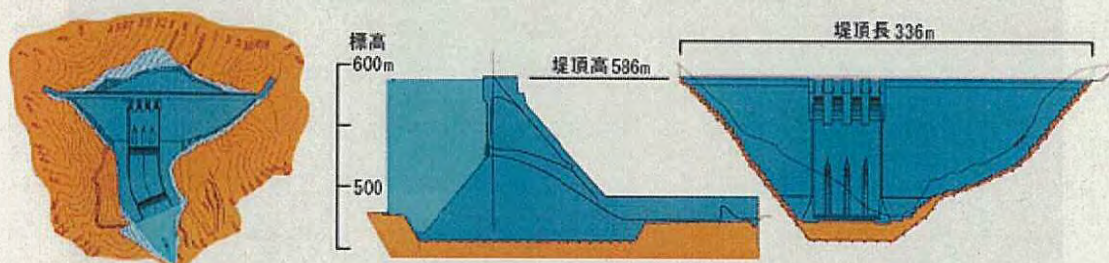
ハッ場ダムの平面図・標準断面図・下流面図 (出典:ハッ場ダム工事事務所HP)
